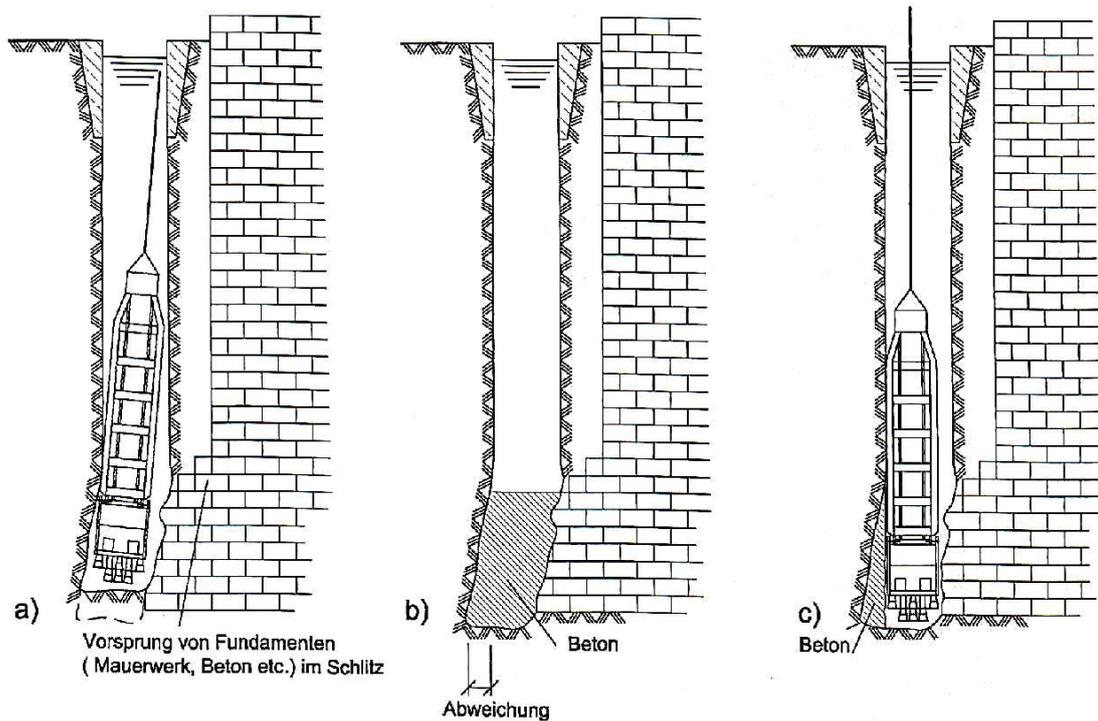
Behandlung hineinragenden Fundamente im Schlitz [17]
